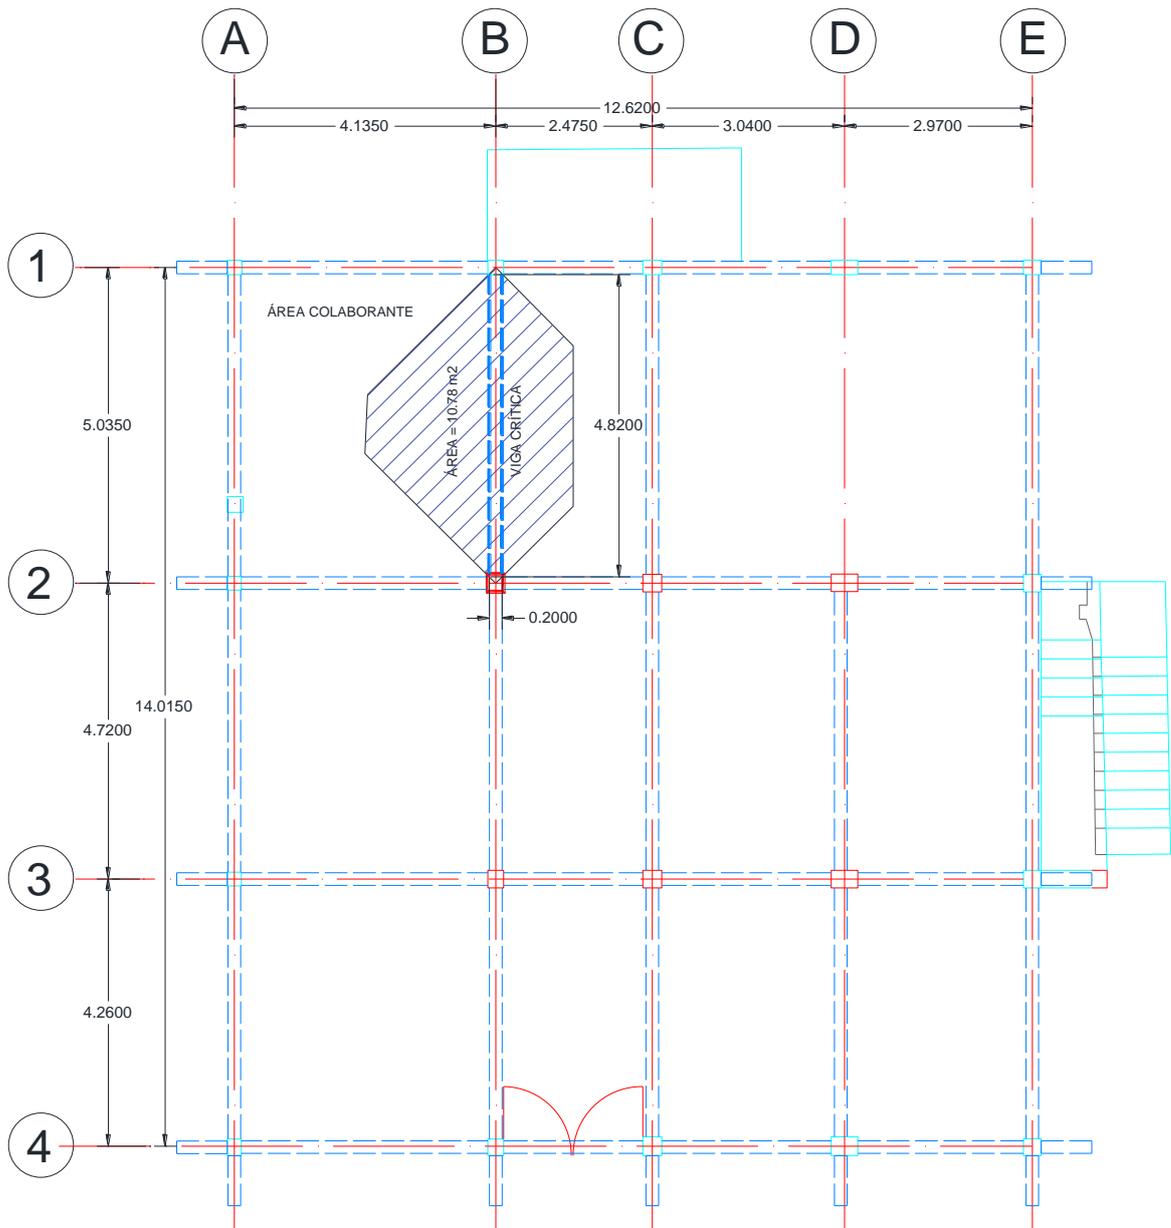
Vista estructural vigas en planta – planta baja – viga crítica
